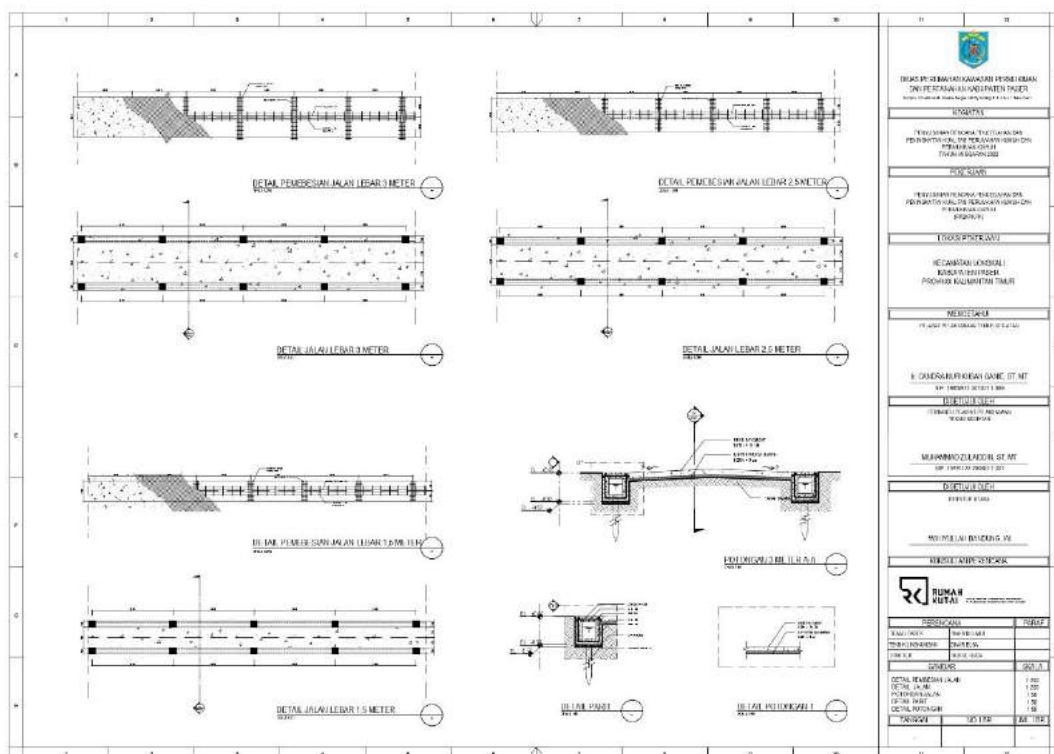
52 Konsep Rencana Jalan Segmen 1 RT.11
